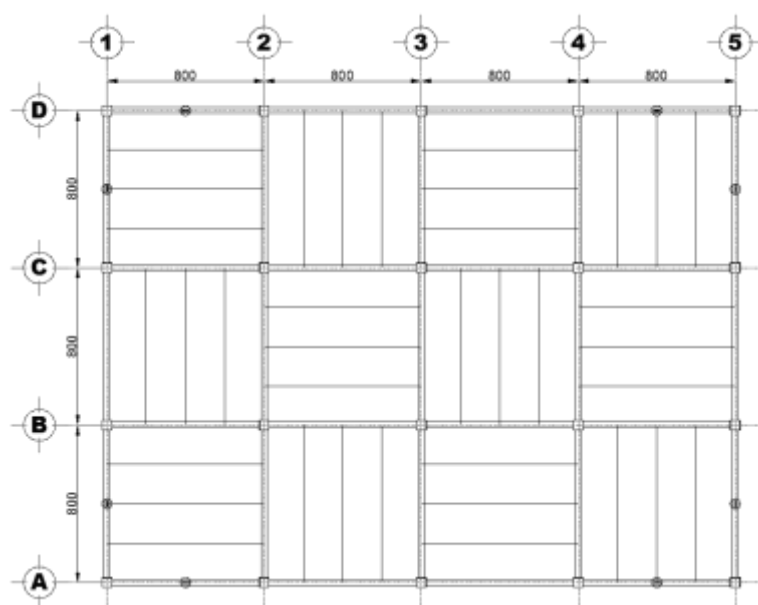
Planta estructural tipo de edificio de oficinas (dimensiones en centímetros)
